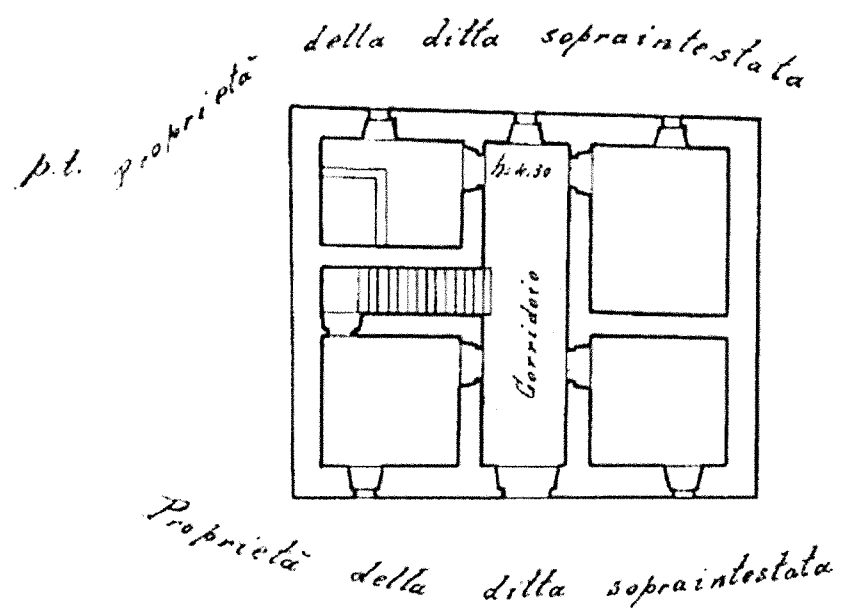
Planimetrie dello stato futuro dell'ex casa colonica (particella 99)
